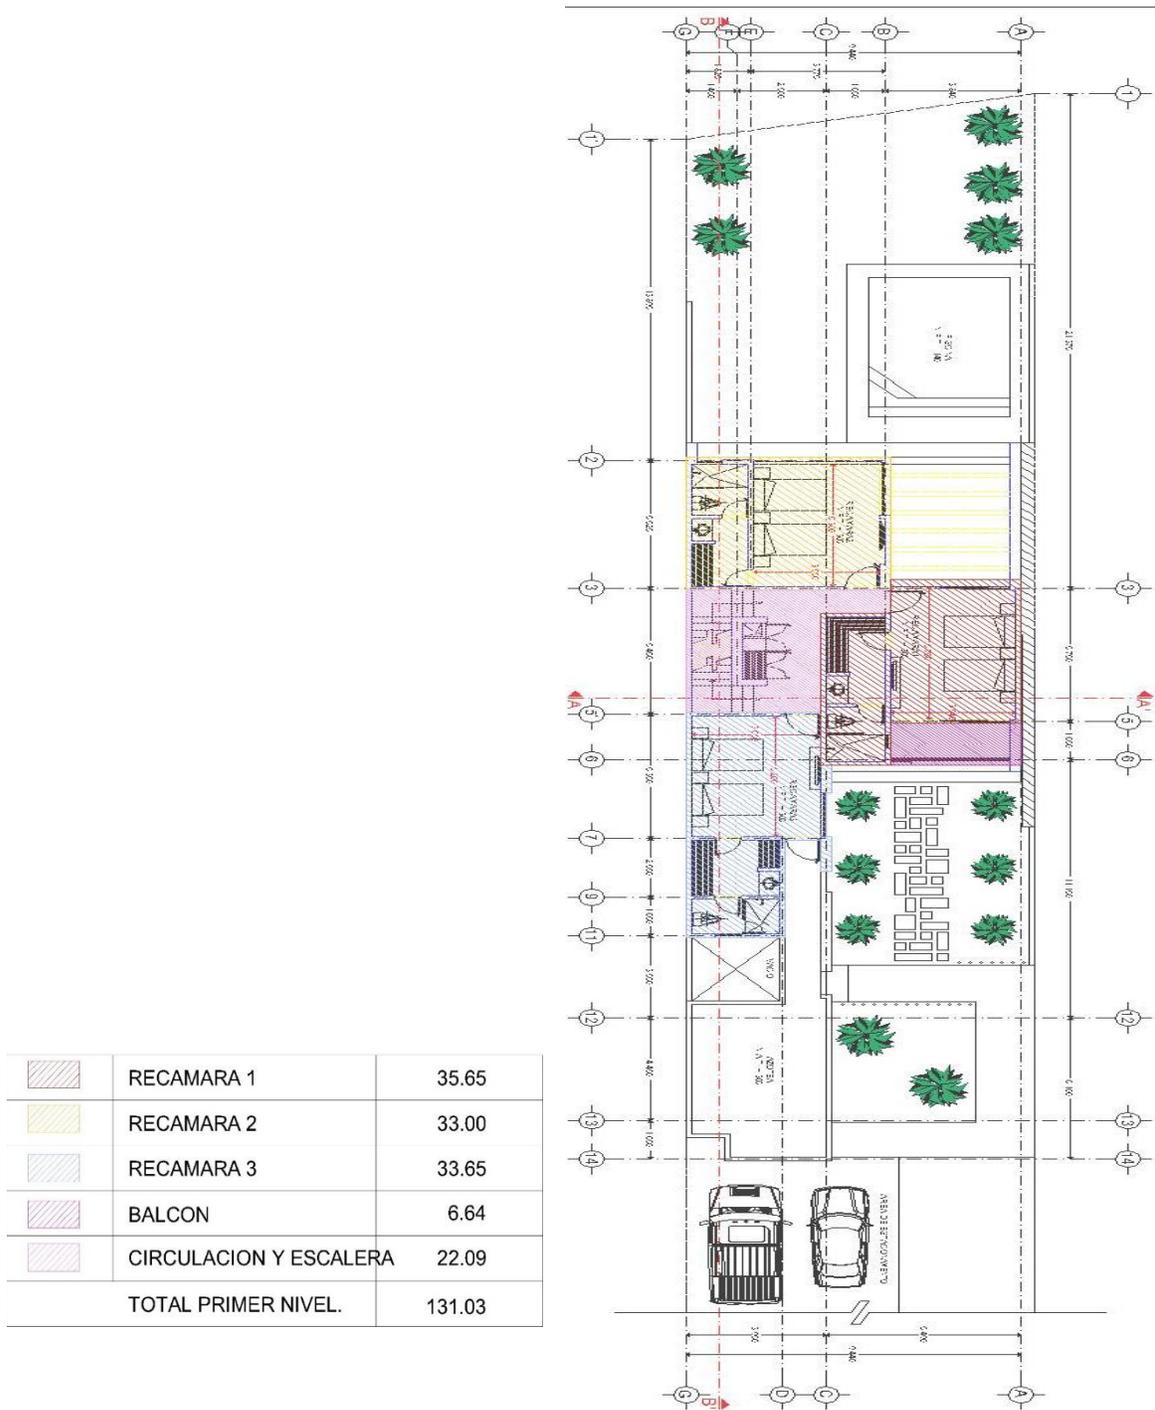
Vista general del primer nivel del proyecto y sus áreas.
